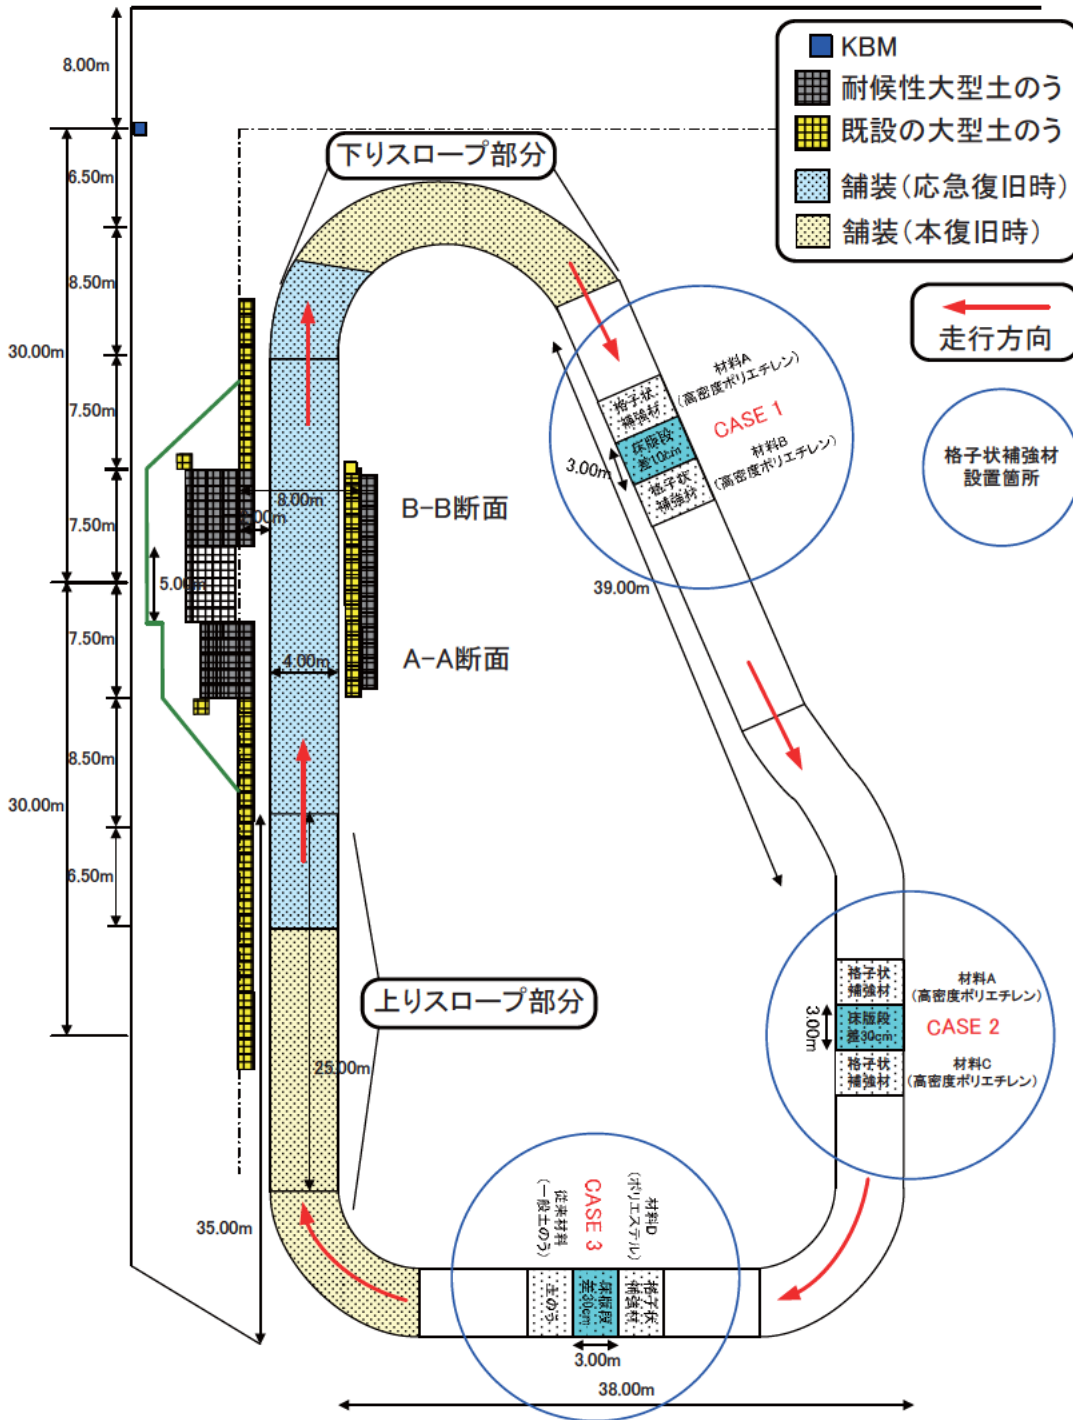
格子状補強材を用いた路面段差復旧の調査位置平面図
